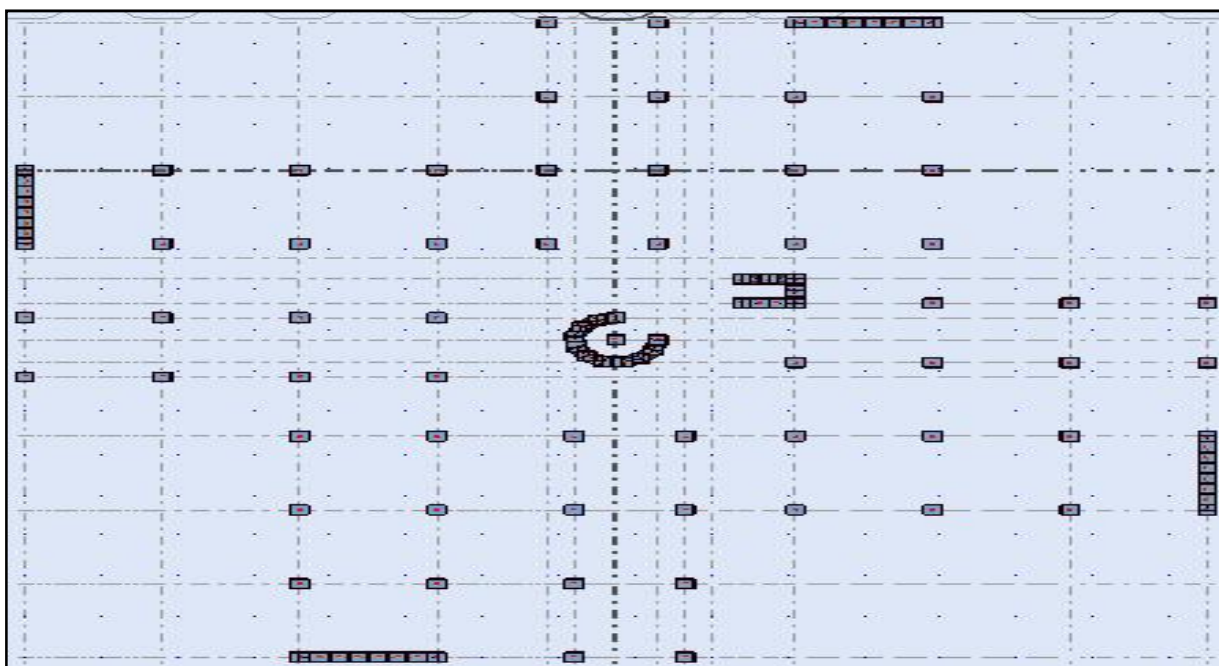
La 2ème disposition des murs voiles et poteaux
